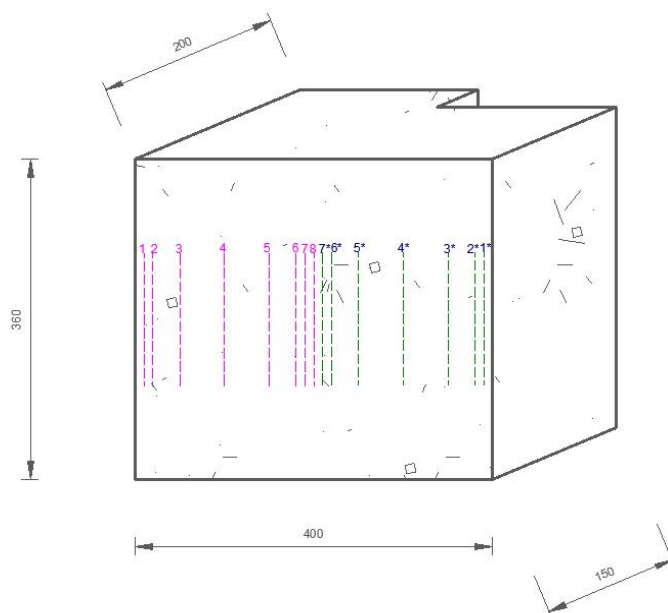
Secções de medição da RE na lajeta sem armadura (lajeta A).
